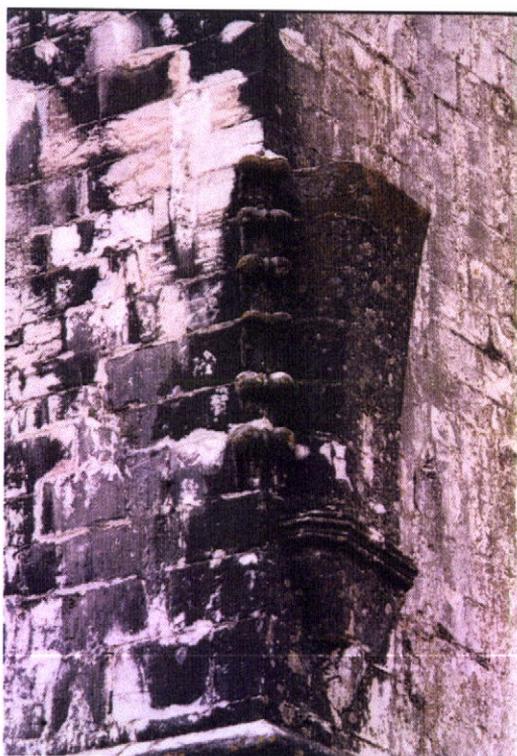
Lado E da Torre de Menagem – pormenor da decoração
